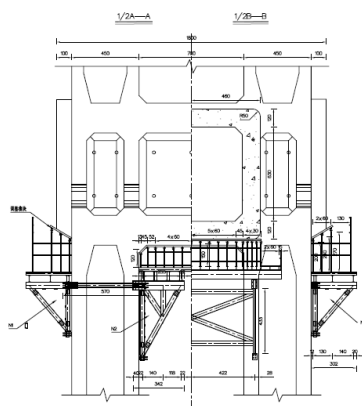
顺桥向下弦 0# 块及系梁施工立面示意图 (单位: cm)
